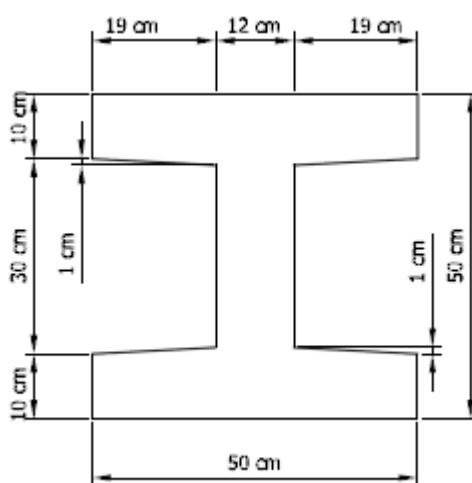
Caso 122R. Detalle de dimensionamiento sección transversal.
